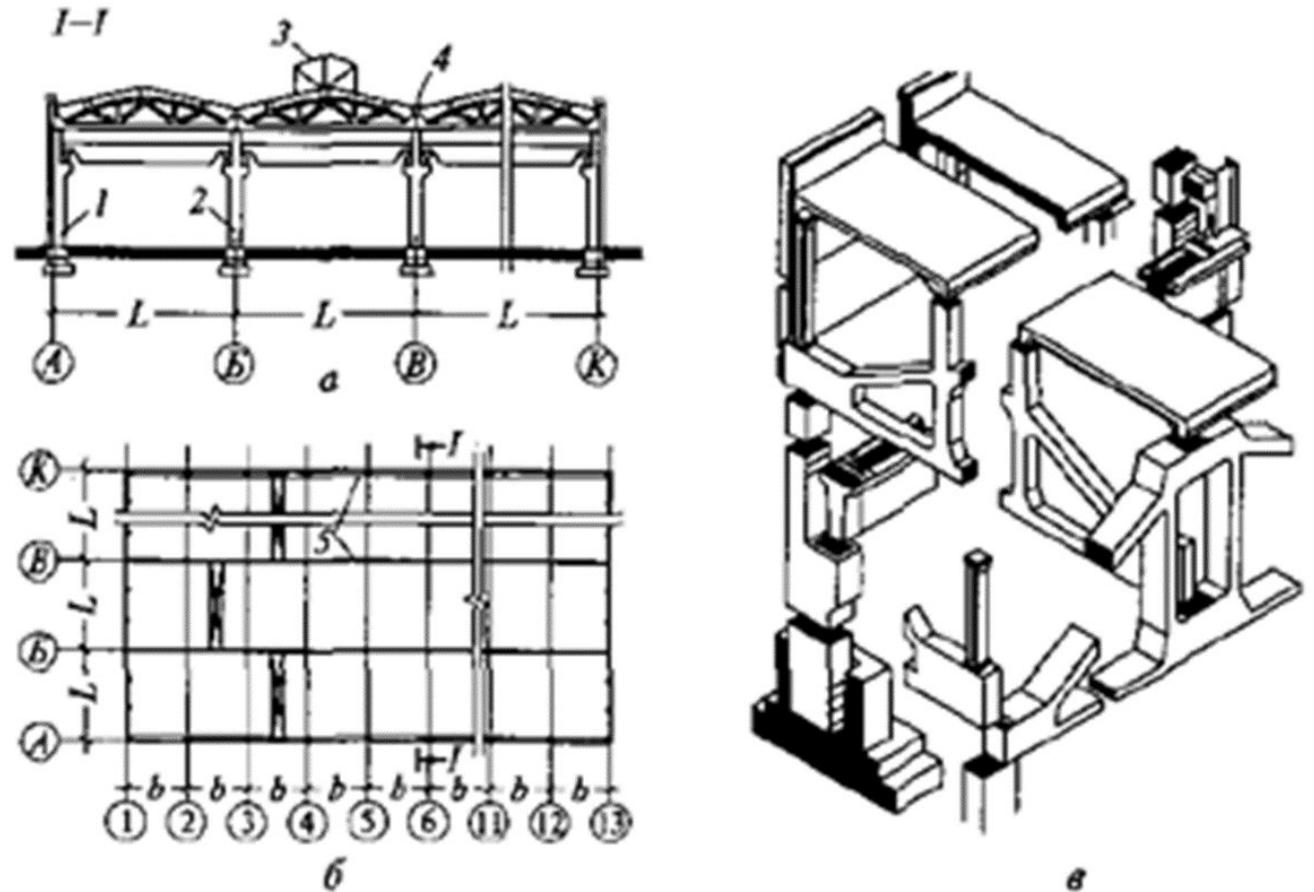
Конструктивно-технологическая схема одноэтажного промздания с железобетонным каркасом:
